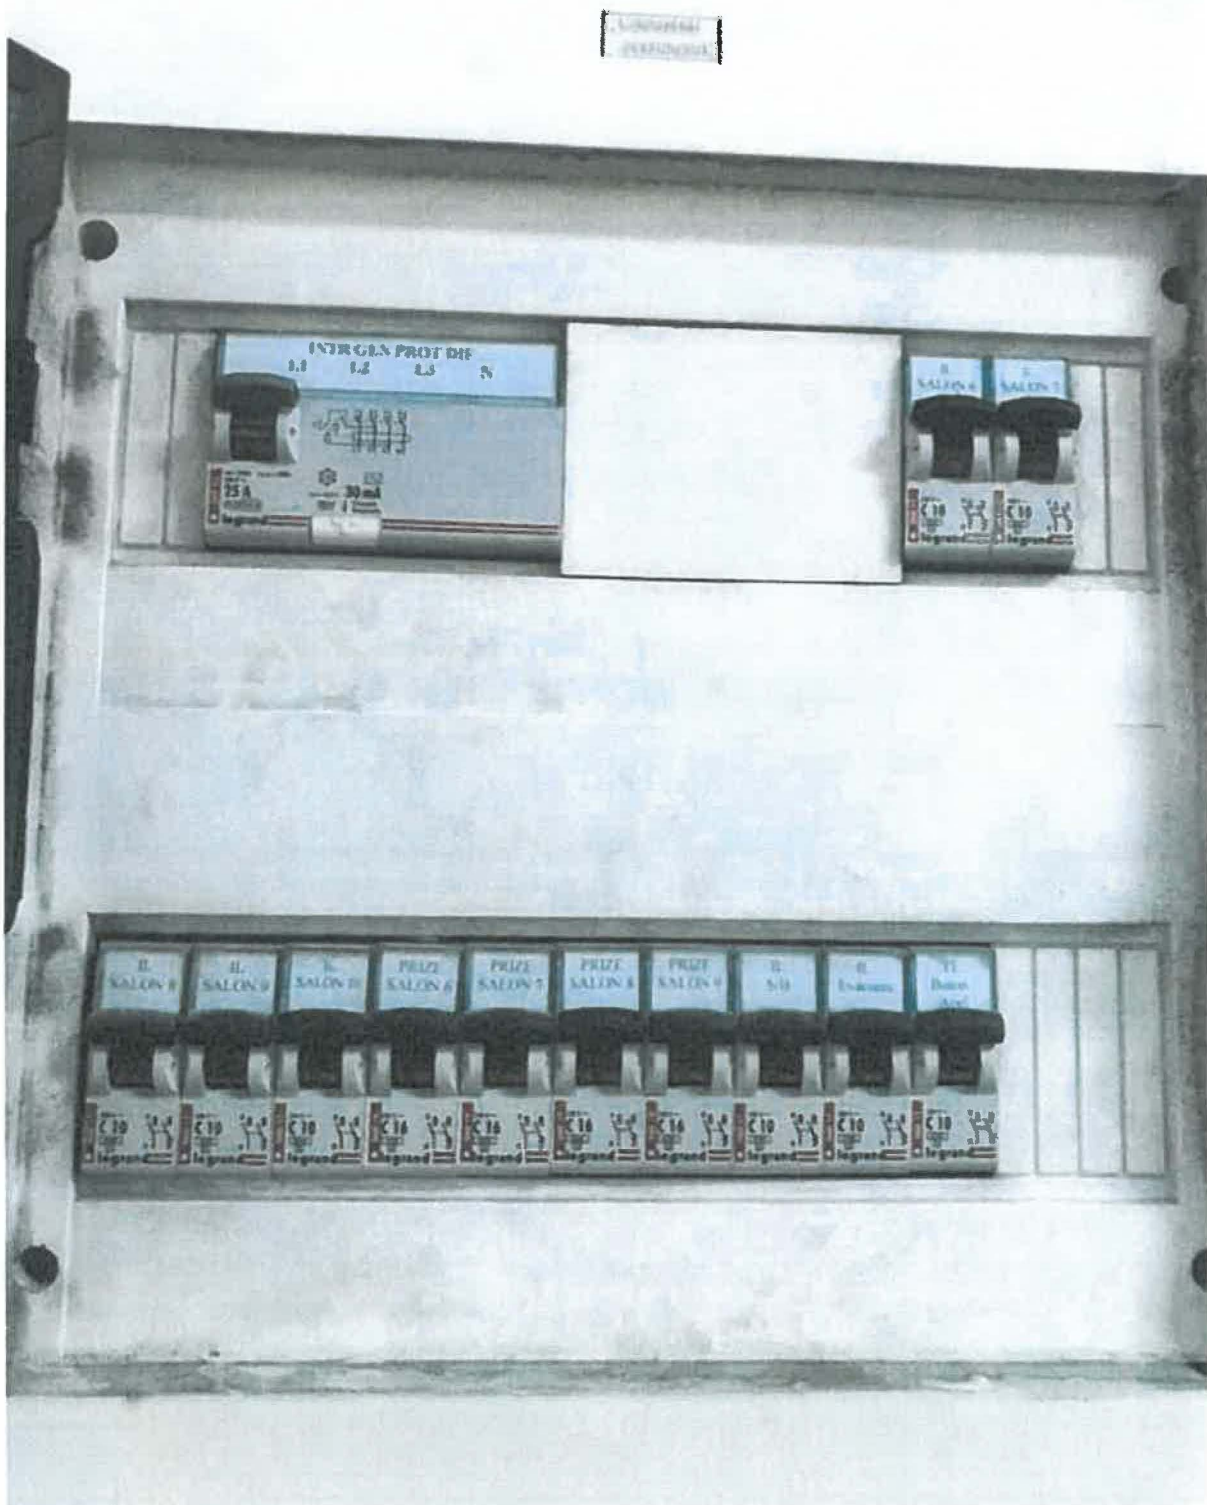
Tablou electric 1 Etaj, Pav. II.
